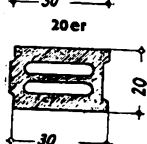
Bimsbetonhohlblocke Bauart Remy
